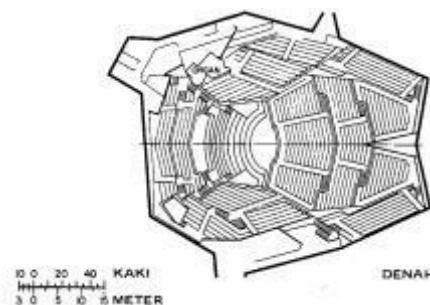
Auditorium denah Lantai Bentuk Tapal Kuda
